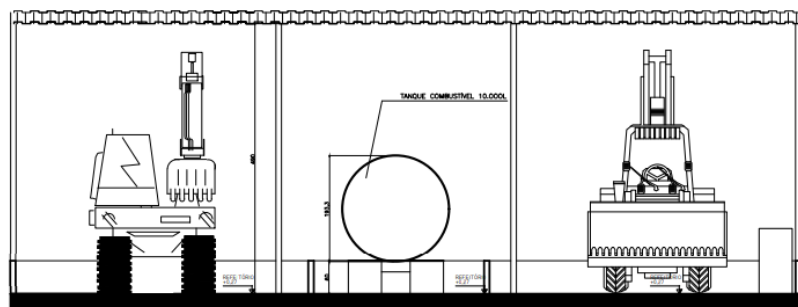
Recorte da pista de abastecimento. Fonte: Informação complementar.
